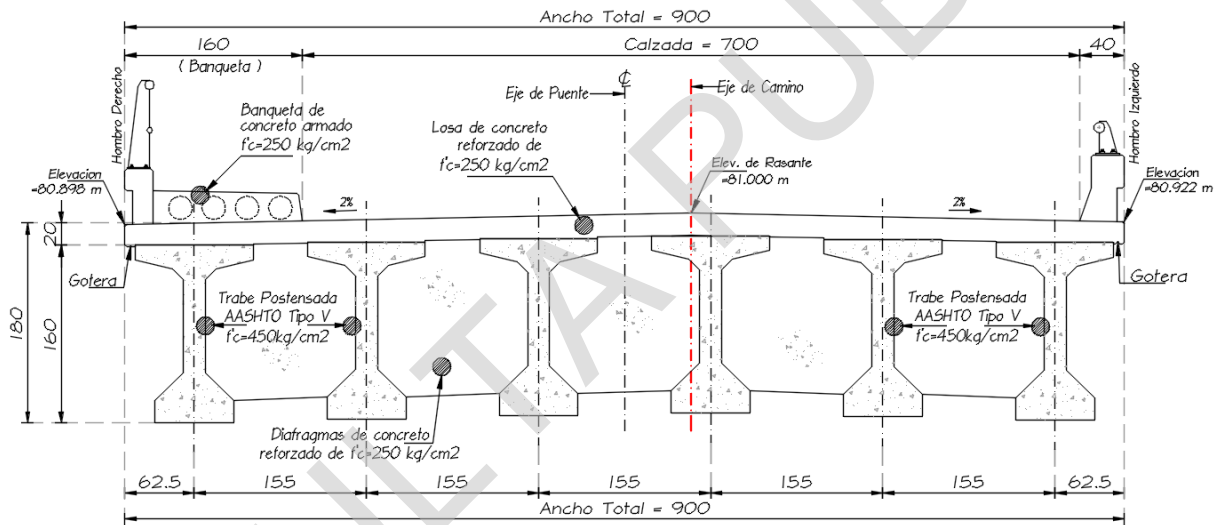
Sección Transversal y planta de geometría de la superestructura.
